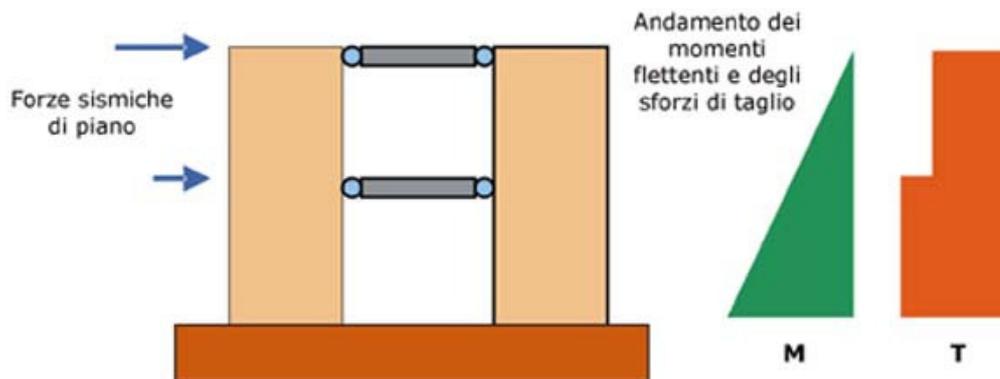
Schema semplificato di calcolo, detto "dell'articolazione", a mensole accoppiate.
